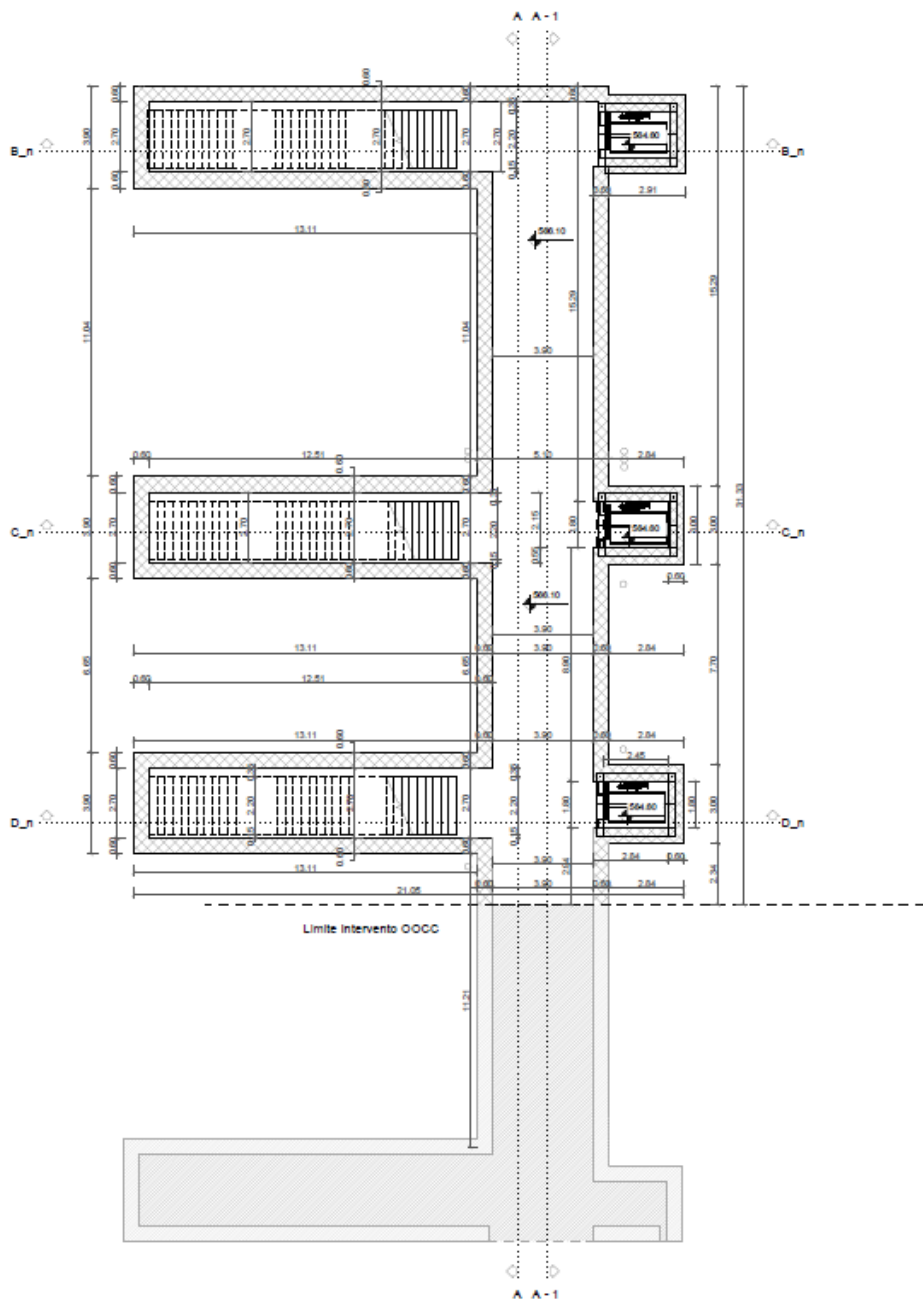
Nuovo sottopasso di stazione SL02 - Pianta
